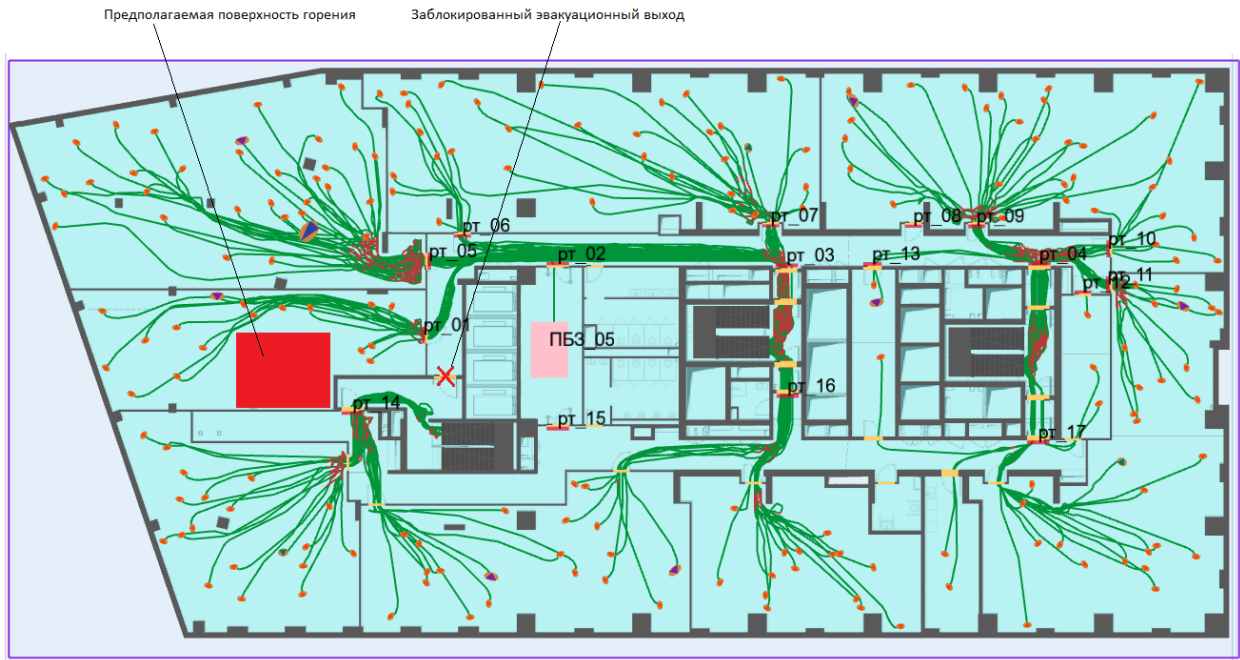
План 5-го этажа и нанесенная на него расчетная (принципиальная) схема эвакуации
